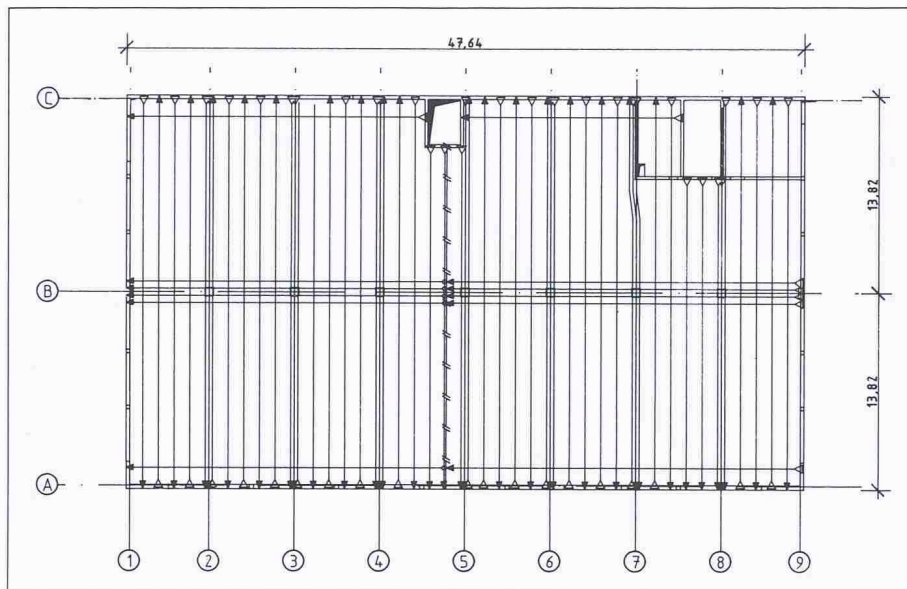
Gebäudegrundriss und Kabelverlauf für die Decken
